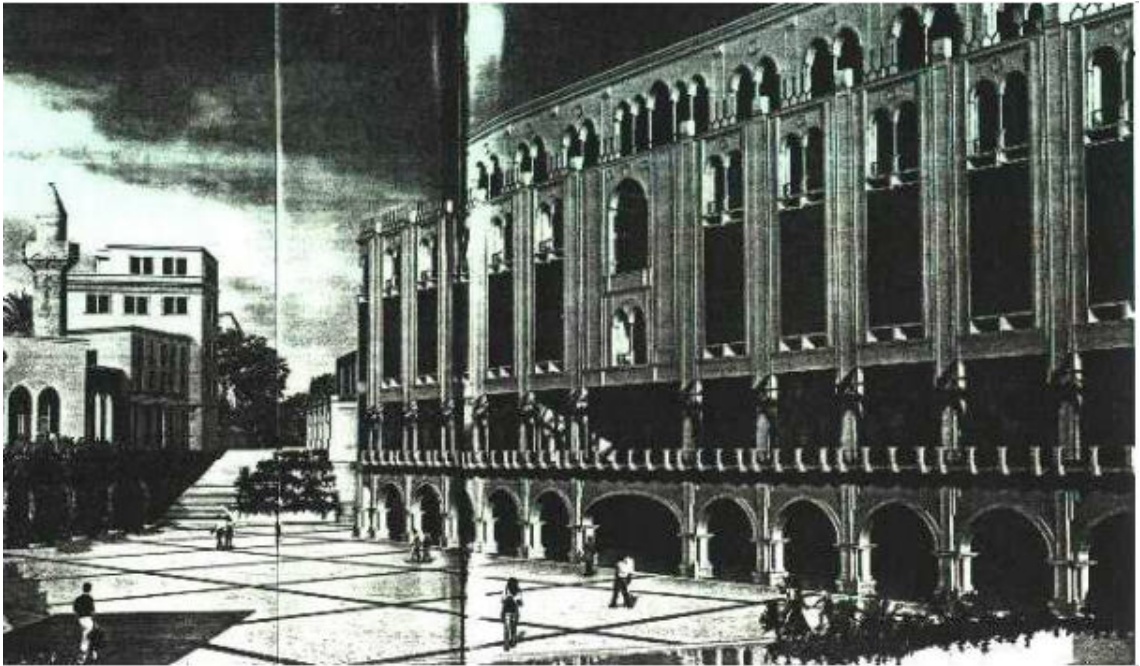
Perspective sur le projet de reconstruction des souks : centre-ville de Beyrouth Source : Solidere.
